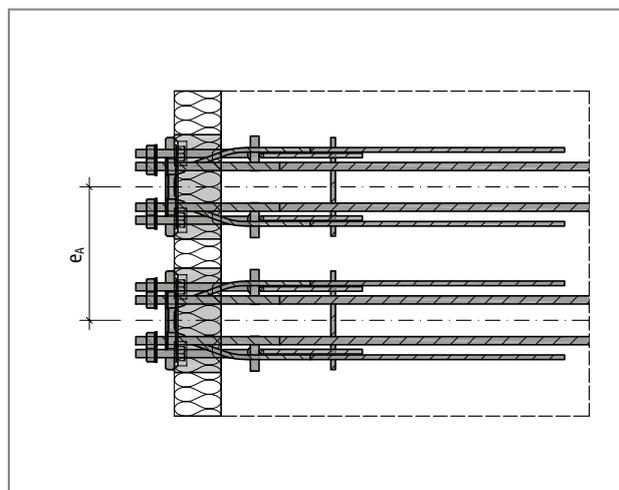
Schöck Isokorb® T tipo SKP: distanza assiale
